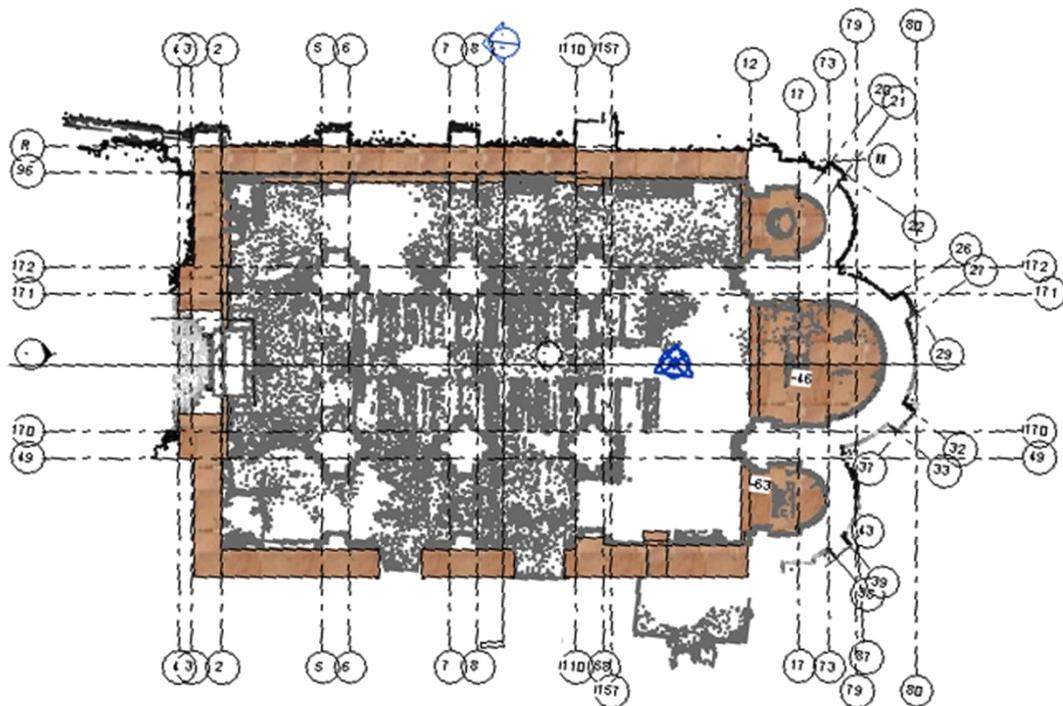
Planta de la nube de punto junto los elementos constructivos del proyecto.
